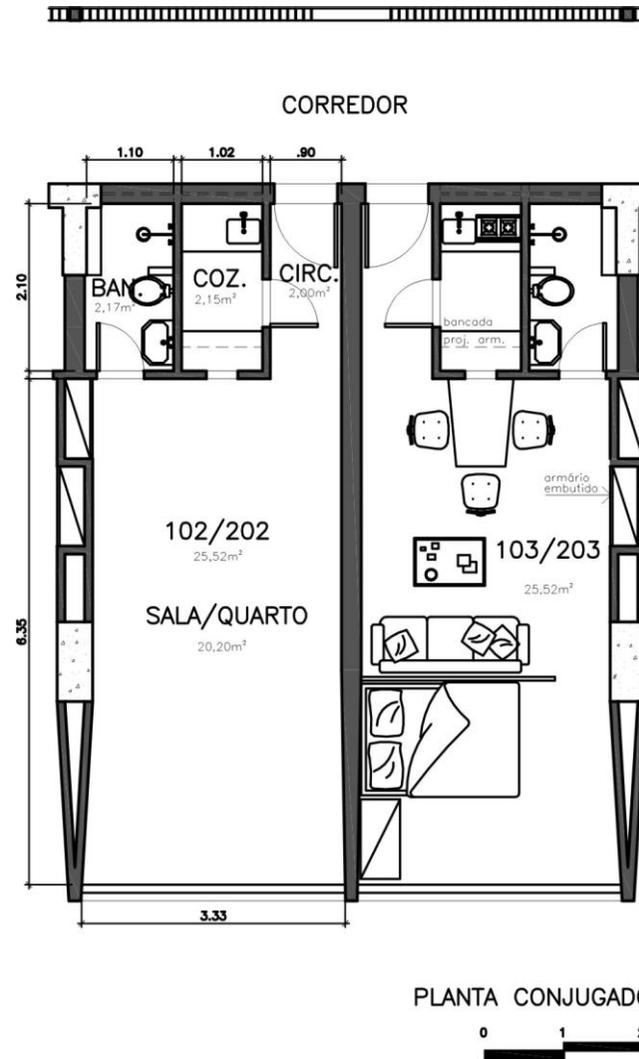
Bloco A, planta do apartamento conjugado. Desenho da autora.
